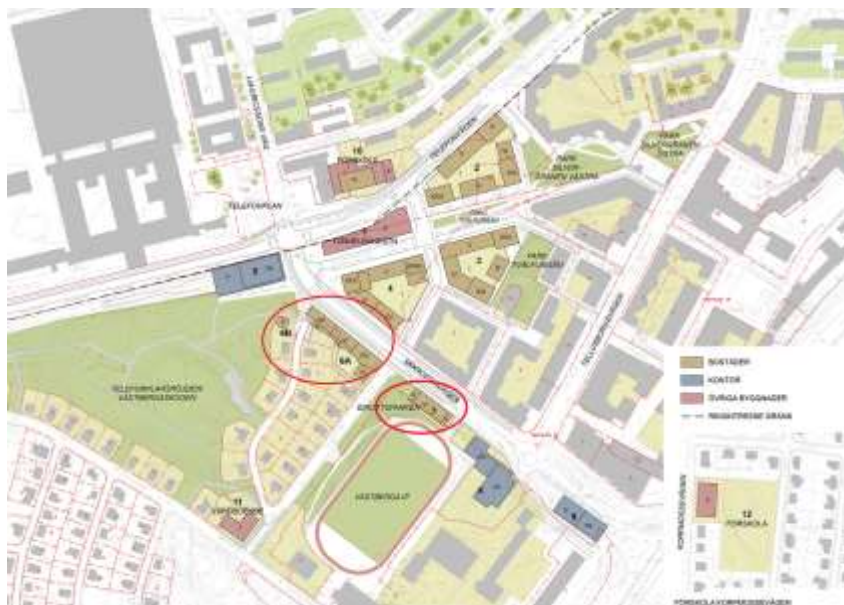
Kvartersindelningen enligt beslutad strukturplan för Centrala Telefonplan. Kvarter 6A och 7 föreslås markanvisas i enlighet med detta beslut, belägna inom rött inringade områden.
